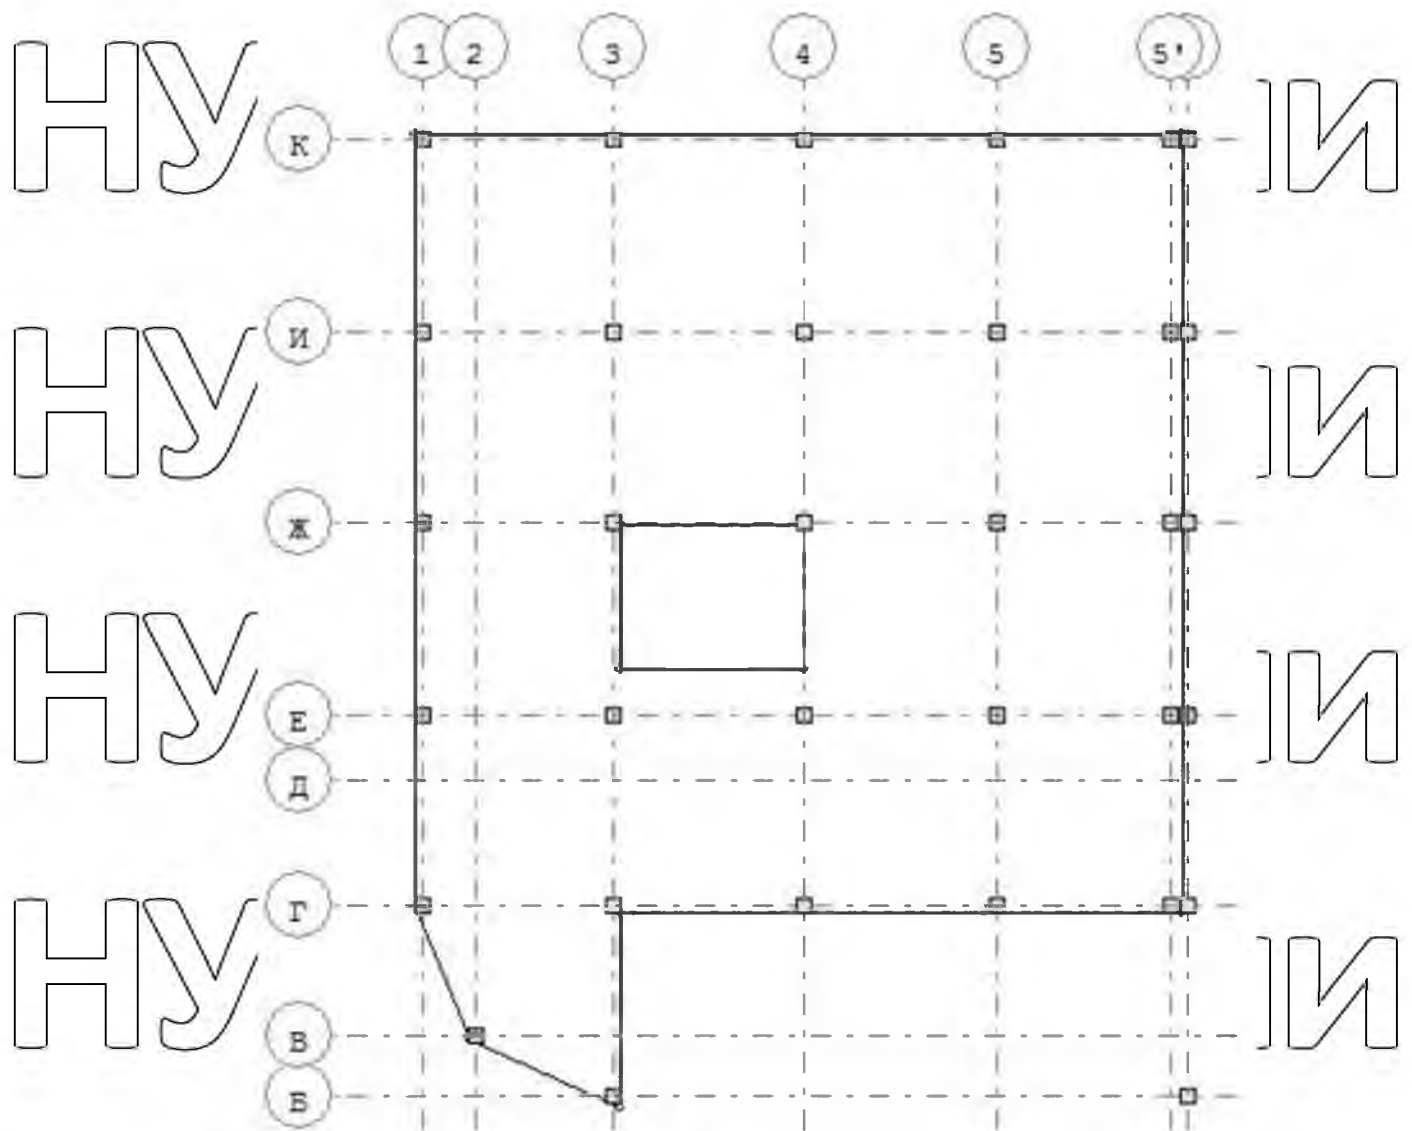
Опалубкове креслення плити перекриття першого поверху
